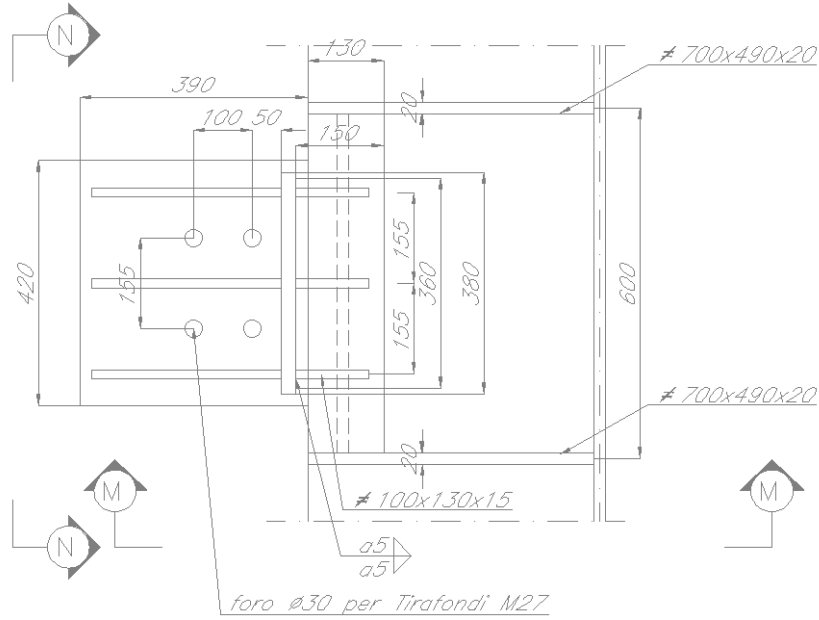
Dettaglio del sistema anti-sollevamento – vista in pianta
